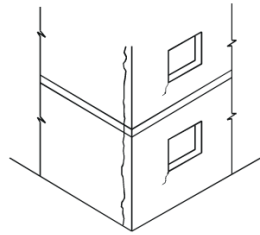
Fissuras verticais causadas por sobrecarga
